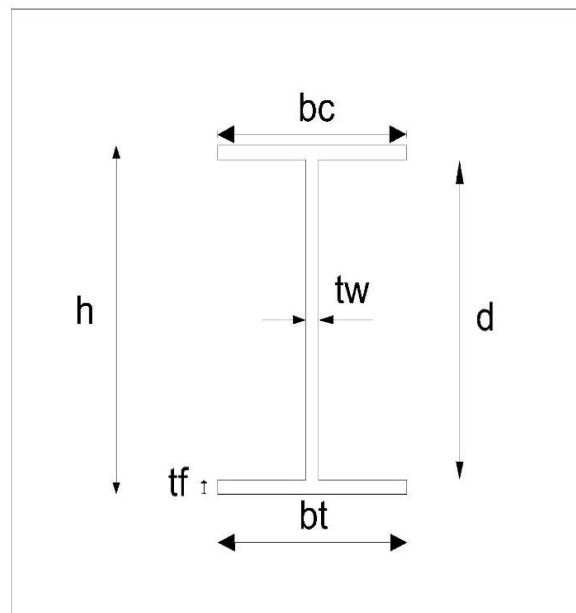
32: Configuración de la viga metálica armada (Fuente: Elaboración Propia)
